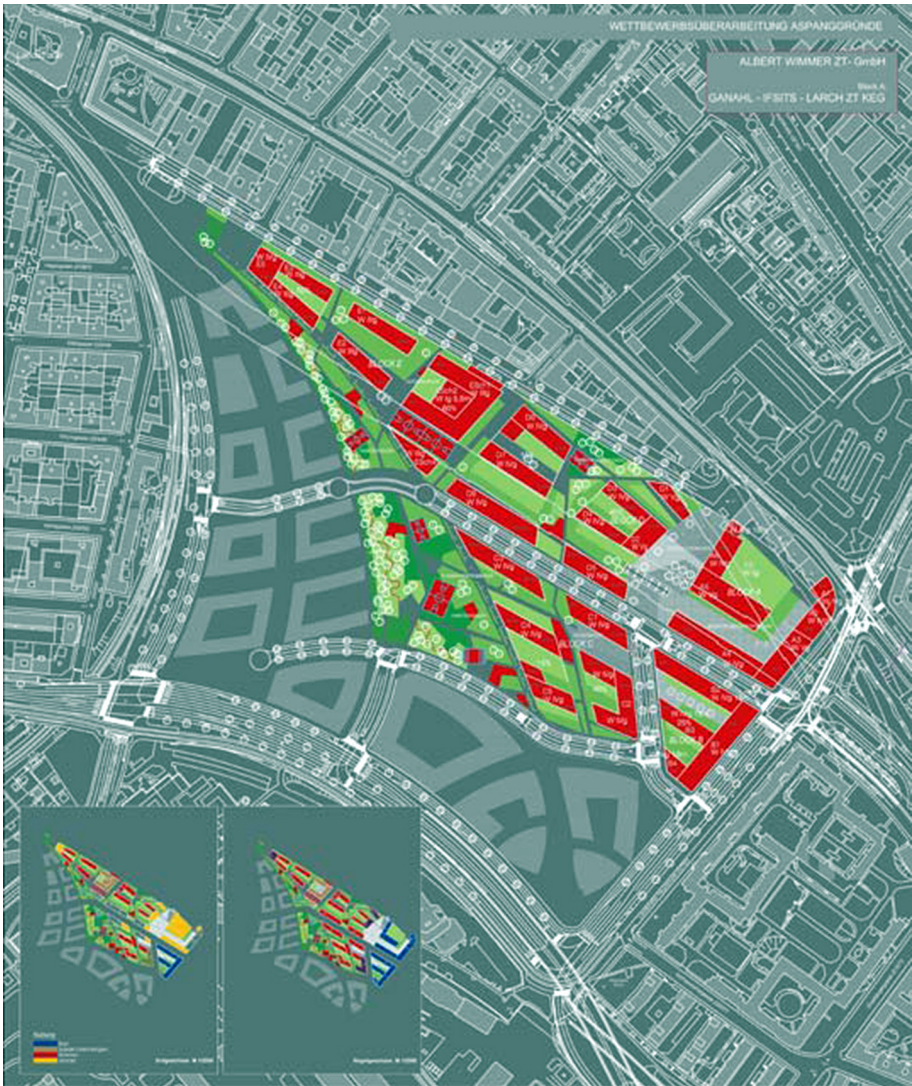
Plan strukturalny Aspanggründe/Eurogat, 2003
